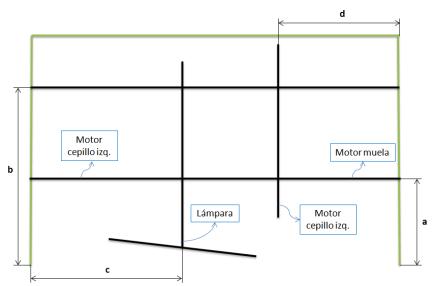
Vista en planta del puesto y distancias relativas entre paredes y barras
